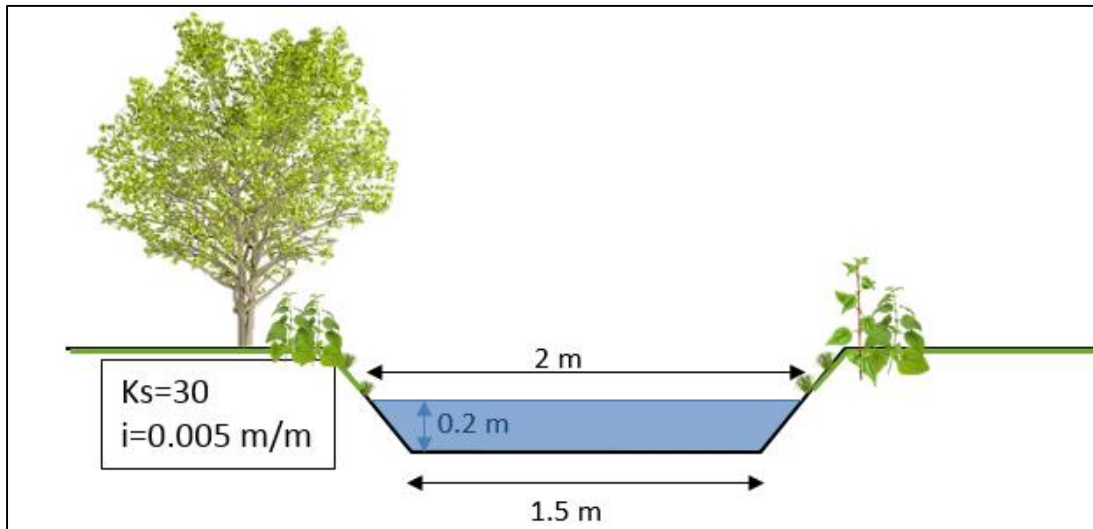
Section type du canal usinier considérée pour le calcul du débit
